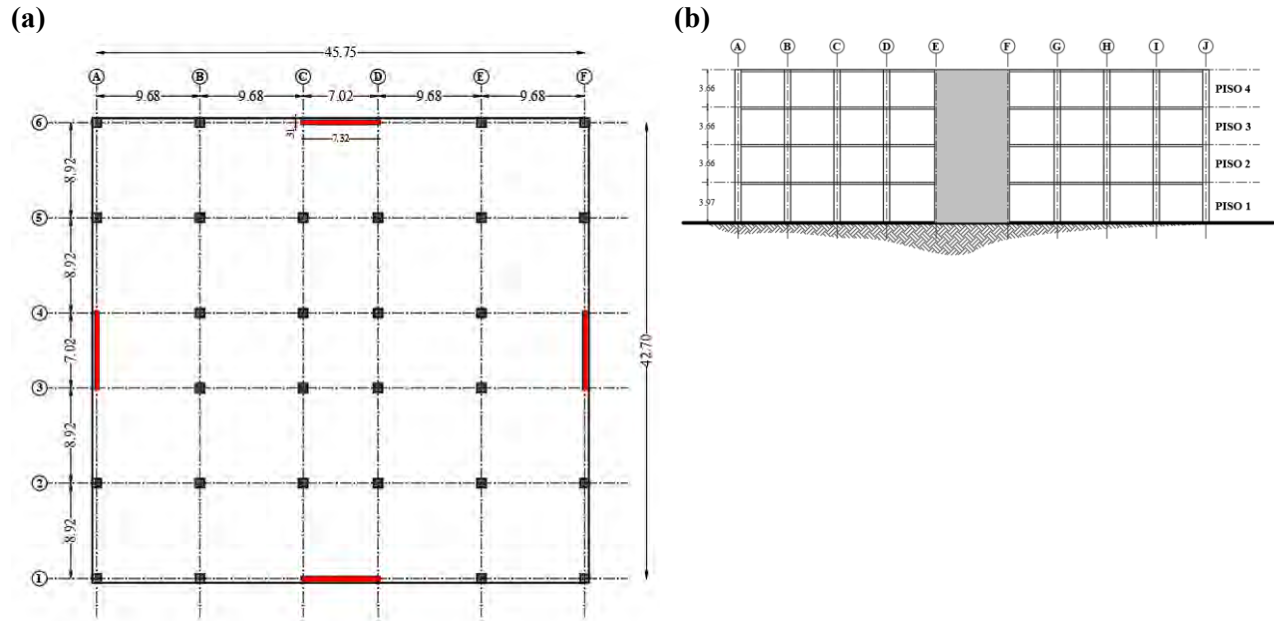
Planta y alzado de los arquetipos de 4 pisos (medidas en metros).
